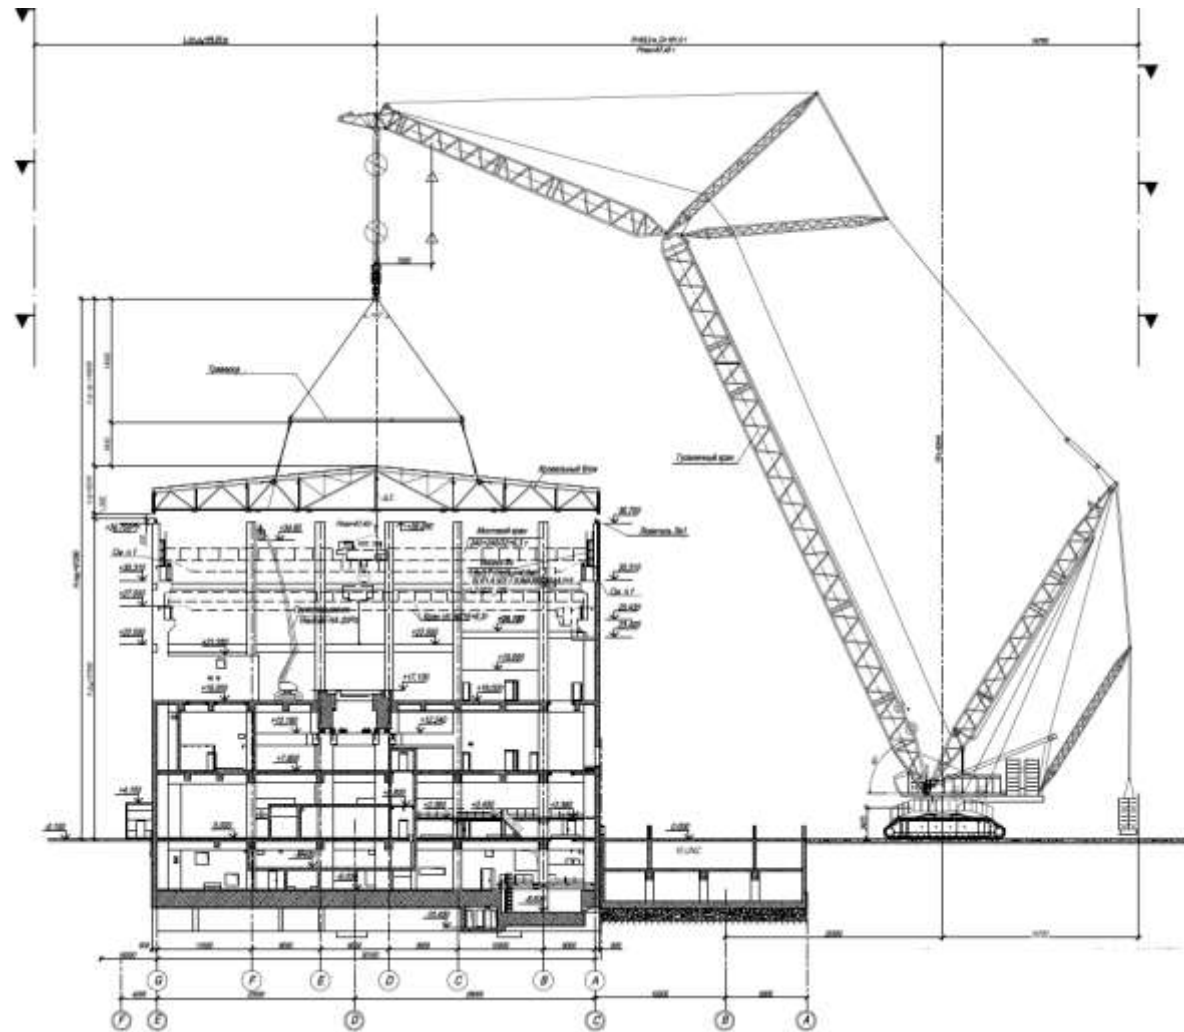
Типовая схема установки блока стальных строительных конструкций кровельного покрытия здания турбины
